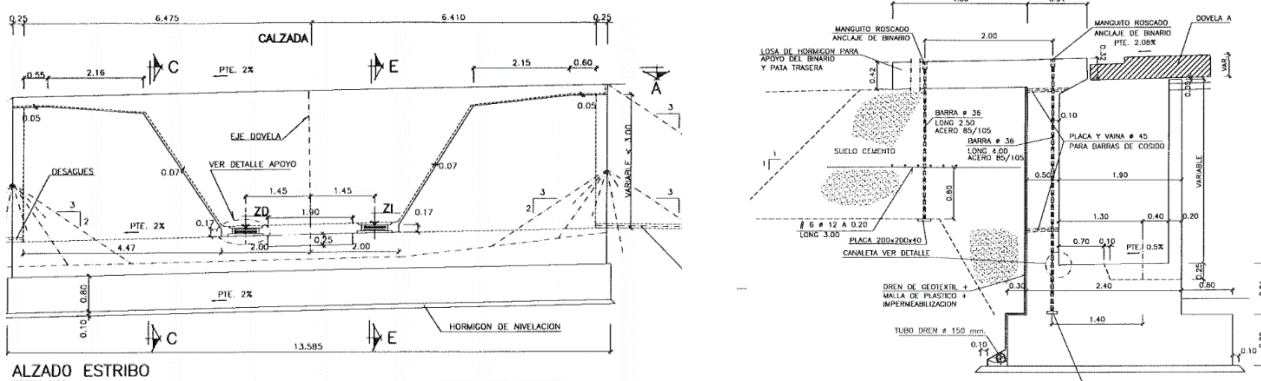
Estribo tipo. Alzado y sección. (Fuente: [2]).
